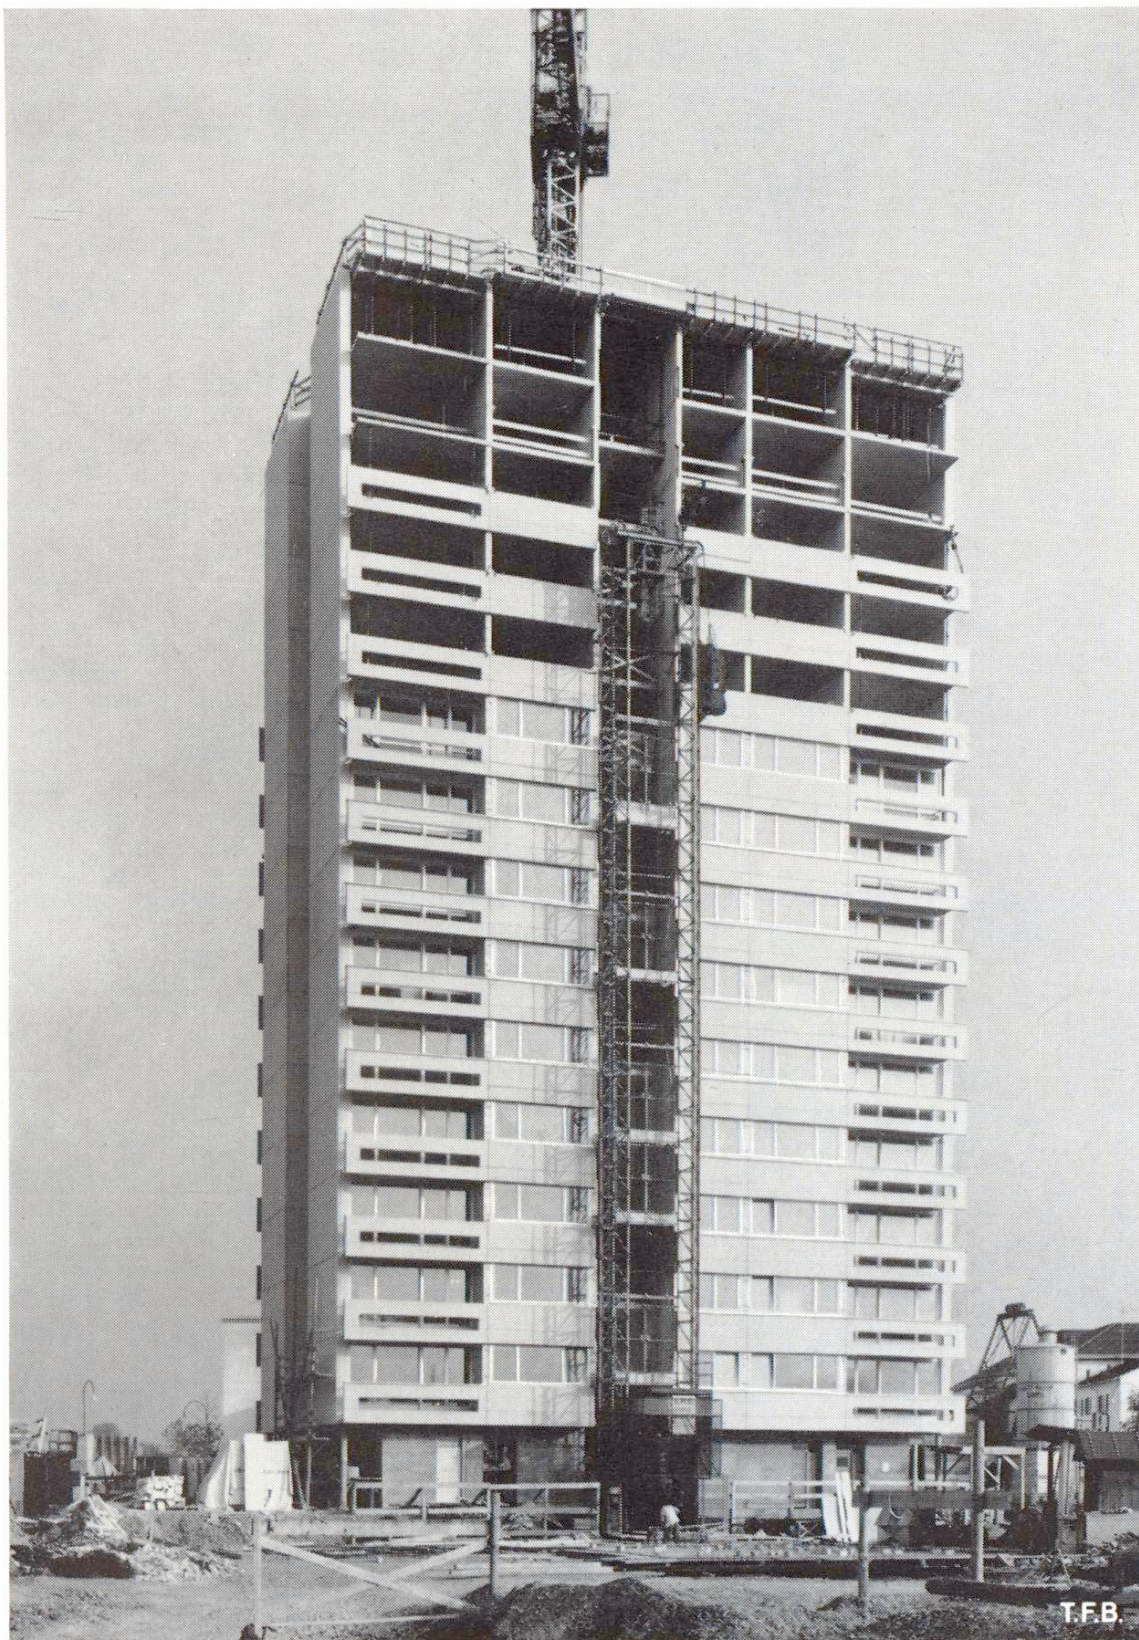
Immeuble-tour construit à Zurich en 1963 par l'entreprise H. Hatt-Haller selon la technique «toutbéton». Les éléments de façade ainsi que les parapets des balcons sont en béton préfabriqué.
